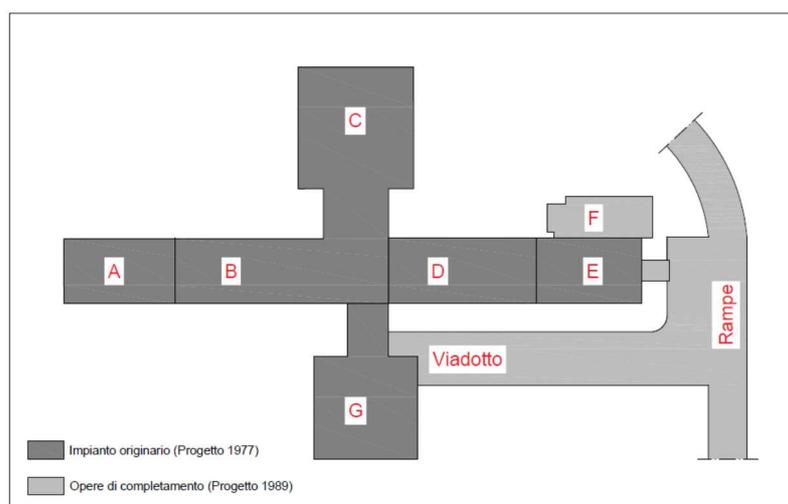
Schema dell'impianto originario e delle opere di completamento
